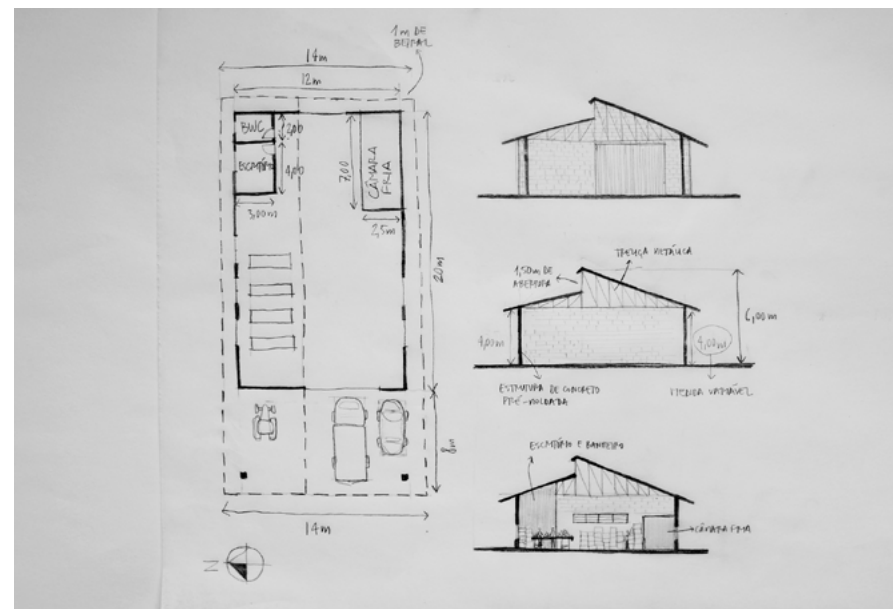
Planta-baixa, cortes e fachada representando as modificações sugeridas.
